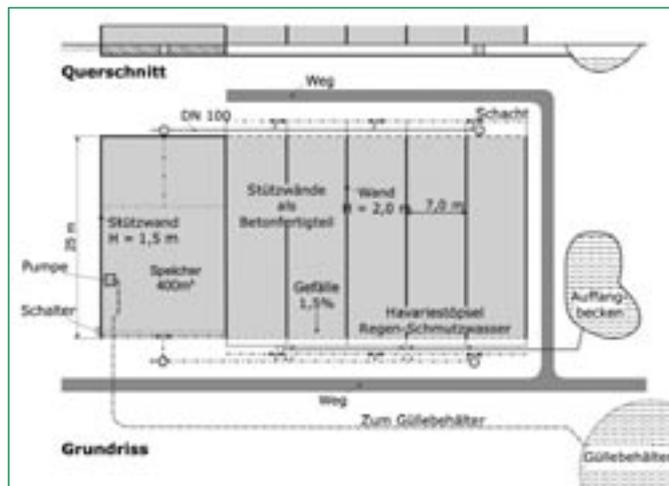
Grundriss und Querschnitt der neuen Festmist – Fahrsilo – Kombination aus Stahlbeton
